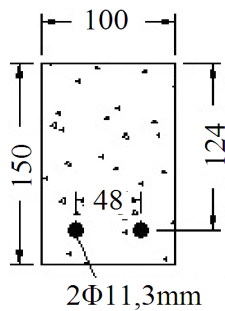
Seção transversal das vigas ensaiadas, com dimensões em mm
